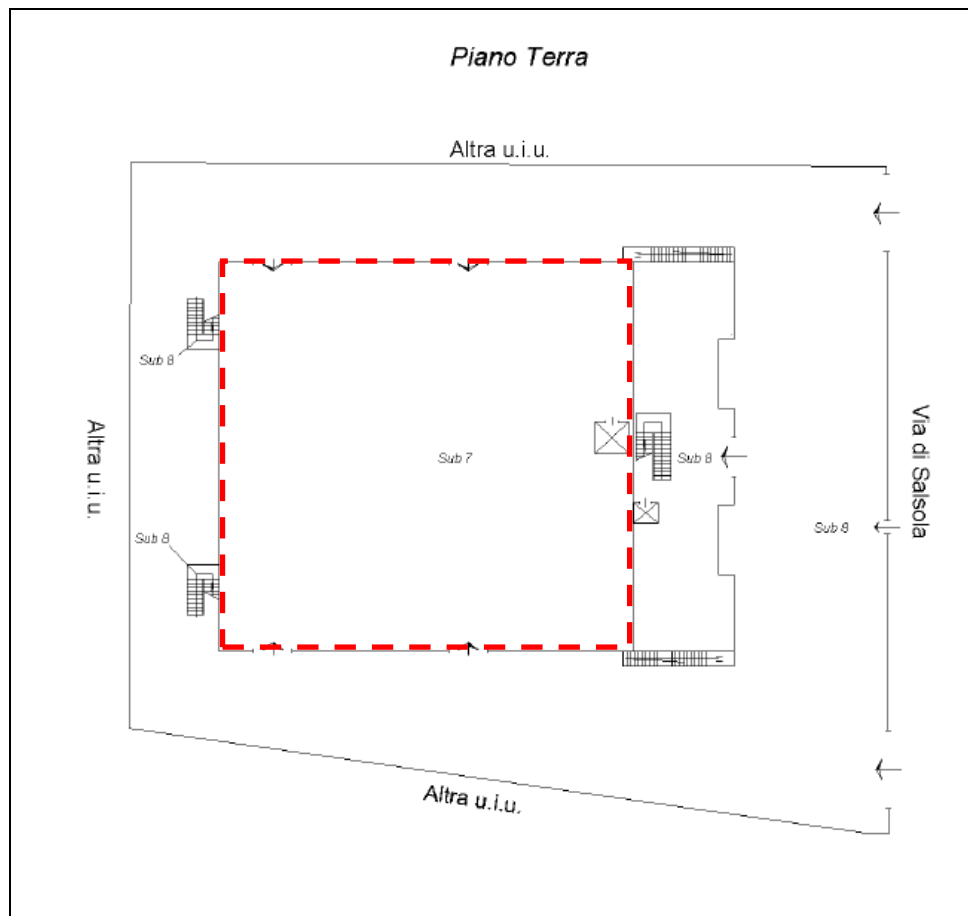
Elaborato planimetrico del pianoterra dell'opificio vigente al 6 maggio 2011 con indicazione dell'unità immobiliare in esame (subalterno 7 della particella 378 foglio n° 75).
